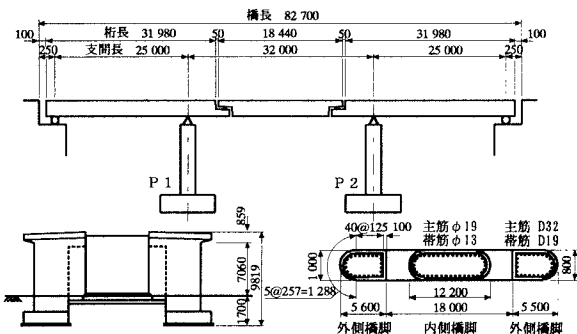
橋梁 B の概要図、P1 橋脚側面図、断面図
